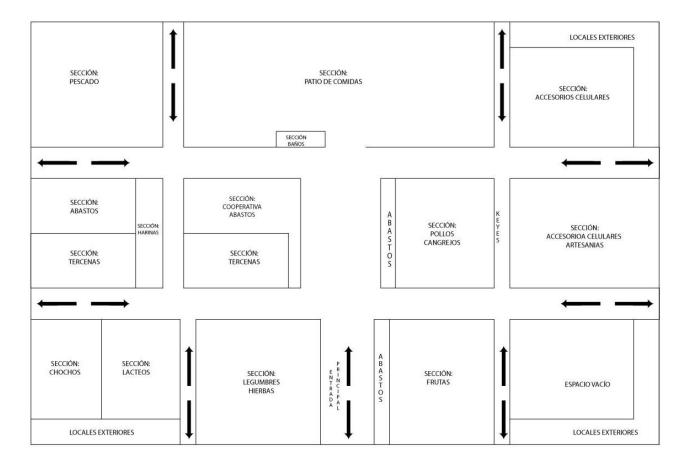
Planta baja Centro Comercial la Condamine
